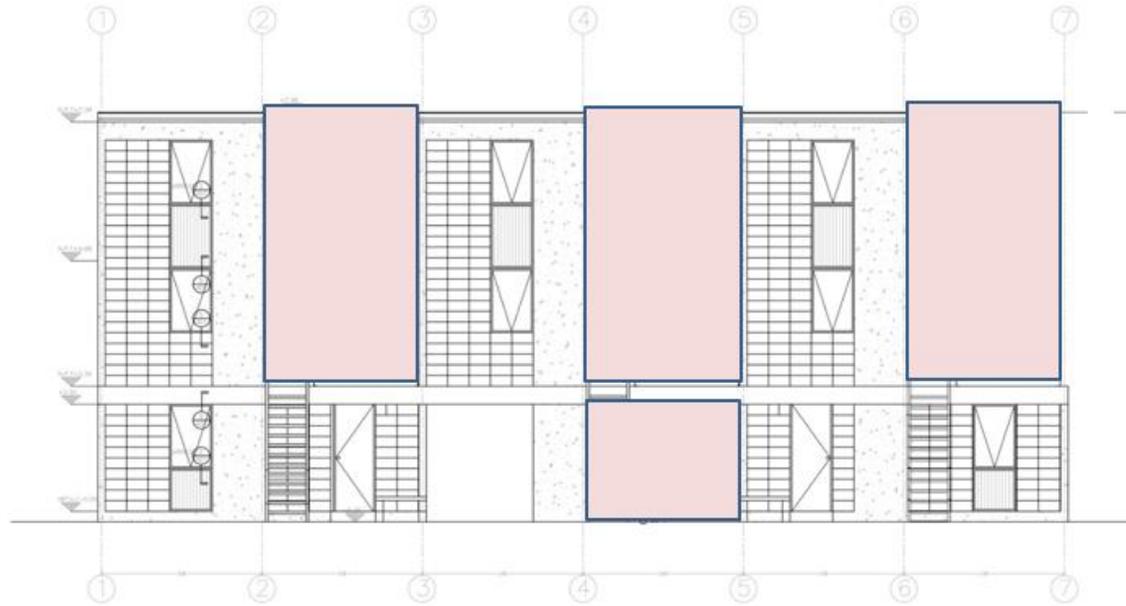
Plano elevaciones, zonas achuradas espacio permitido para autoconstrucción
